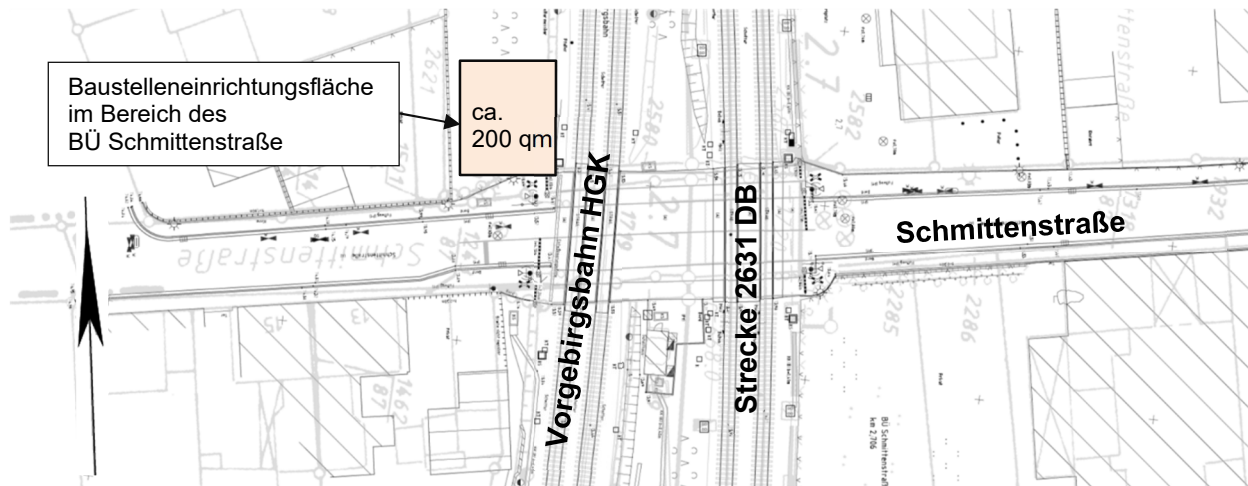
Baustelleneinrichtungsfläche BÜ Schmittstraße
